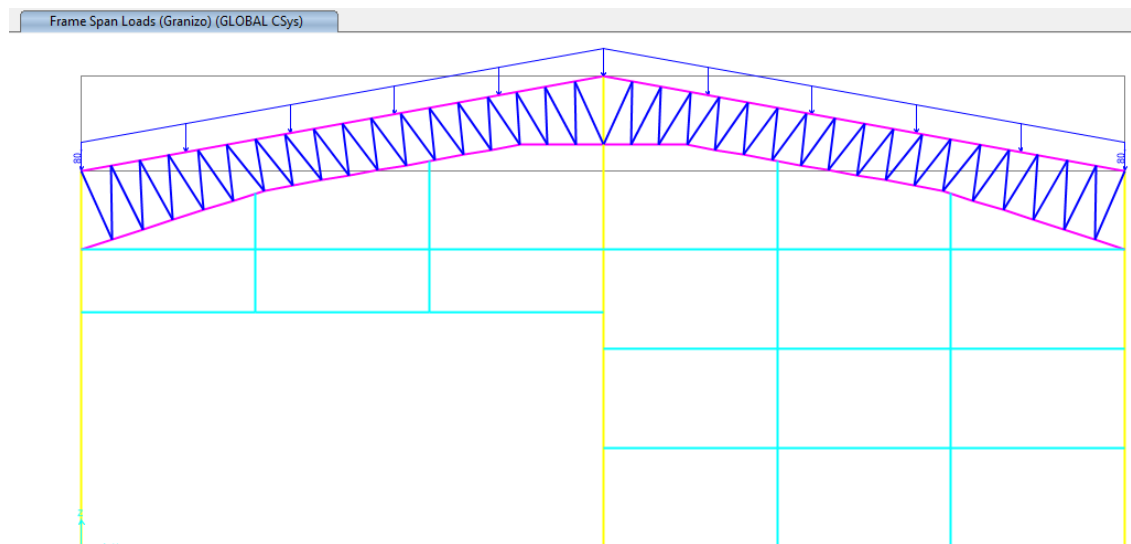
Aplicación de carga de granizo sobre la cubierta en SAP2000
